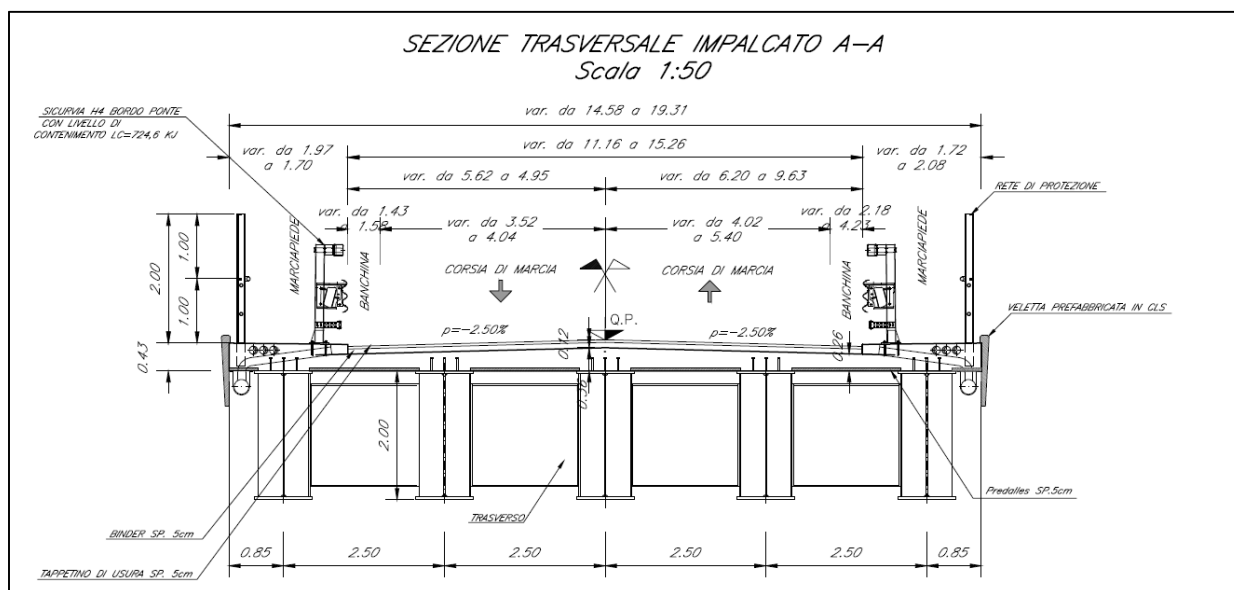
Sezione tipo Cavalcaferrovia – IV03
